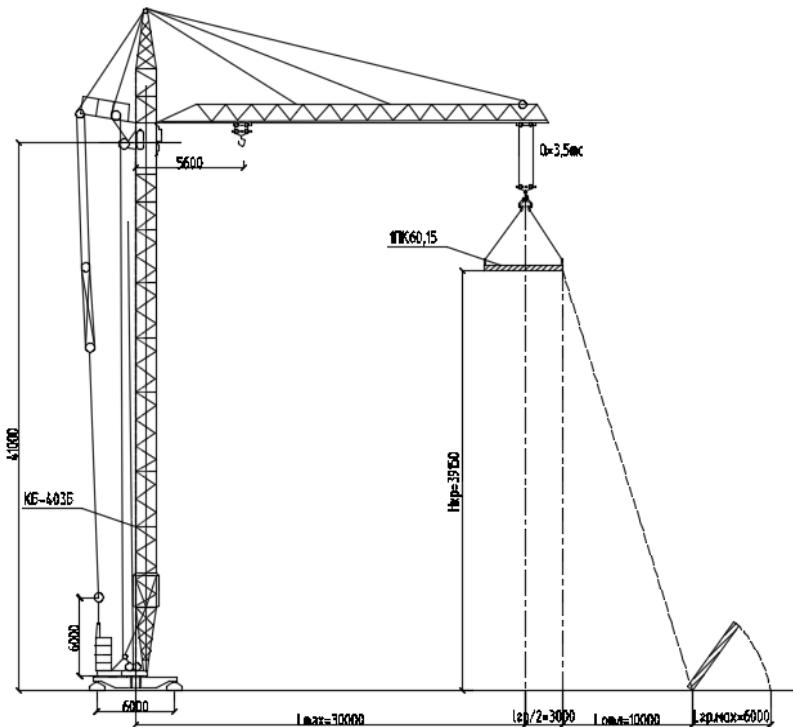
Пример расчетной схемы определения опасной зоны башенного крана (выполнил студент Р.И. Зубаиров, гр. ПГС-11-1)
